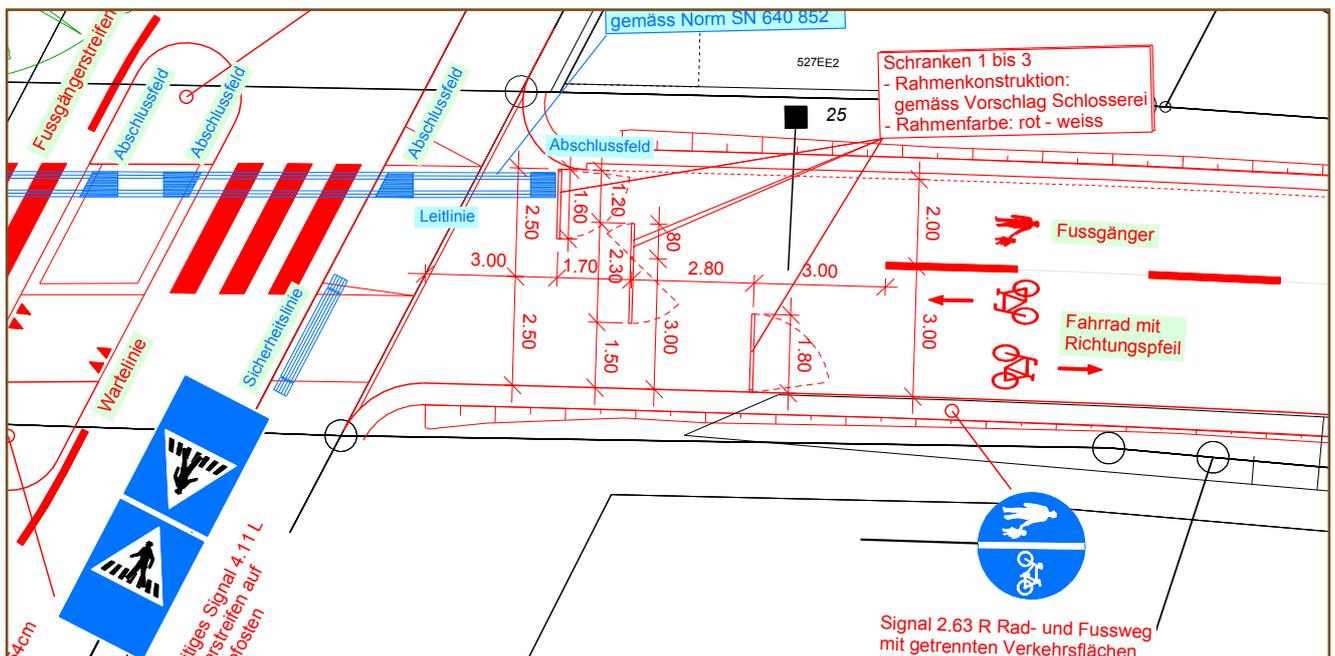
Vermasste Schrankenelemente im Grundriss
